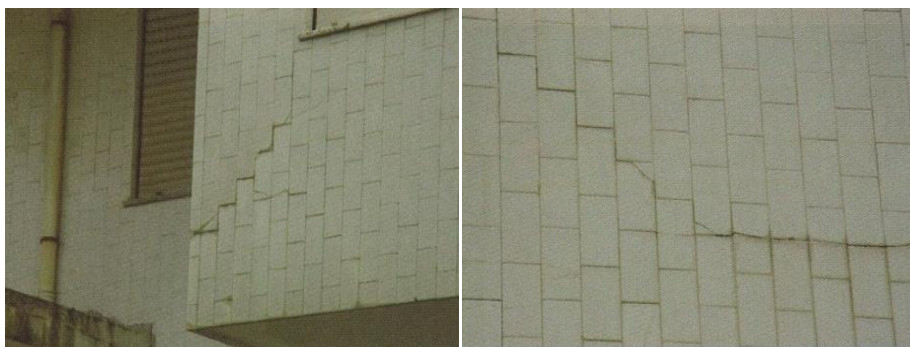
Fissuração sobre parede deformada devido aos movimentos da estrutura, acentuada pela sujeira [7]
